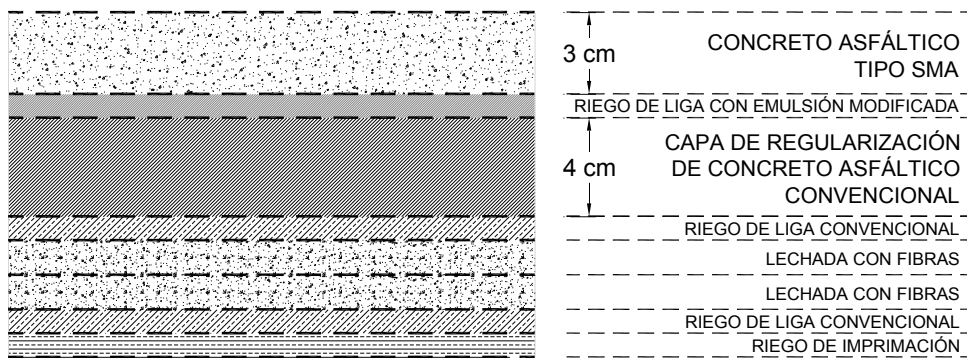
Estructura de pavimento, capas estructurales y riegos
